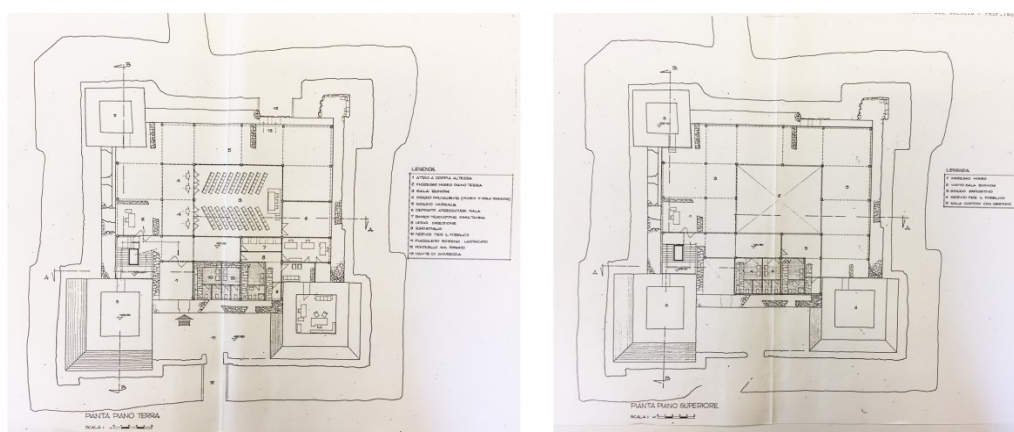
Planimetrie di progetto del castello di San Michele del 1986 (ASBEAP_CA-OR)
